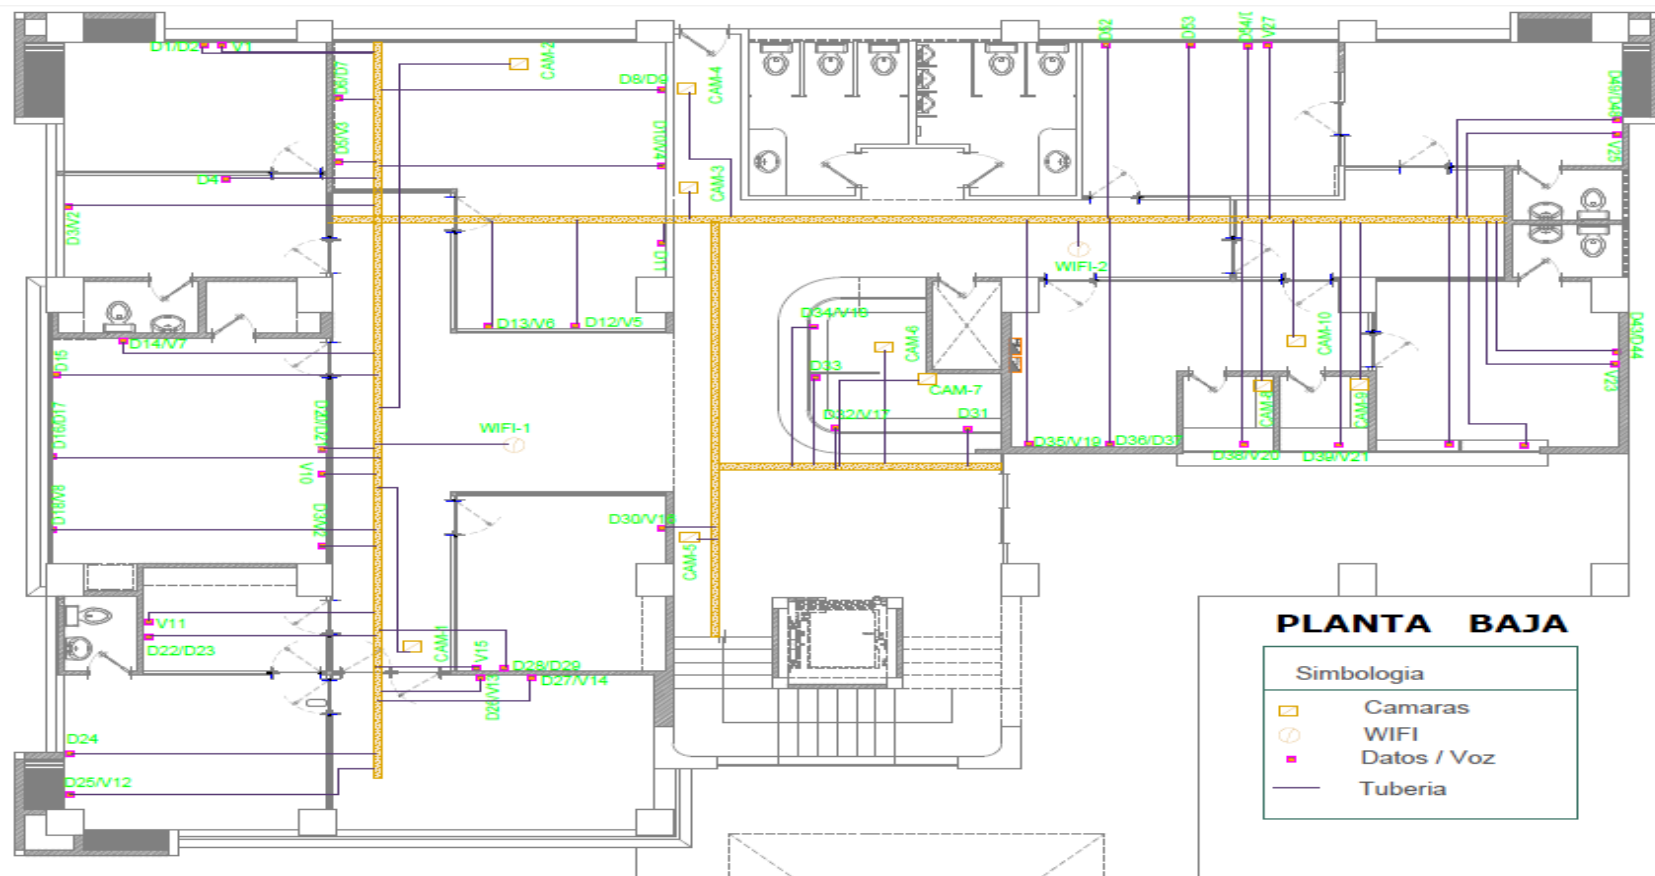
Plano correspondiente Planta Baja Elaborado por: (GADPLR [Imagen], 2014), Investigadoras
